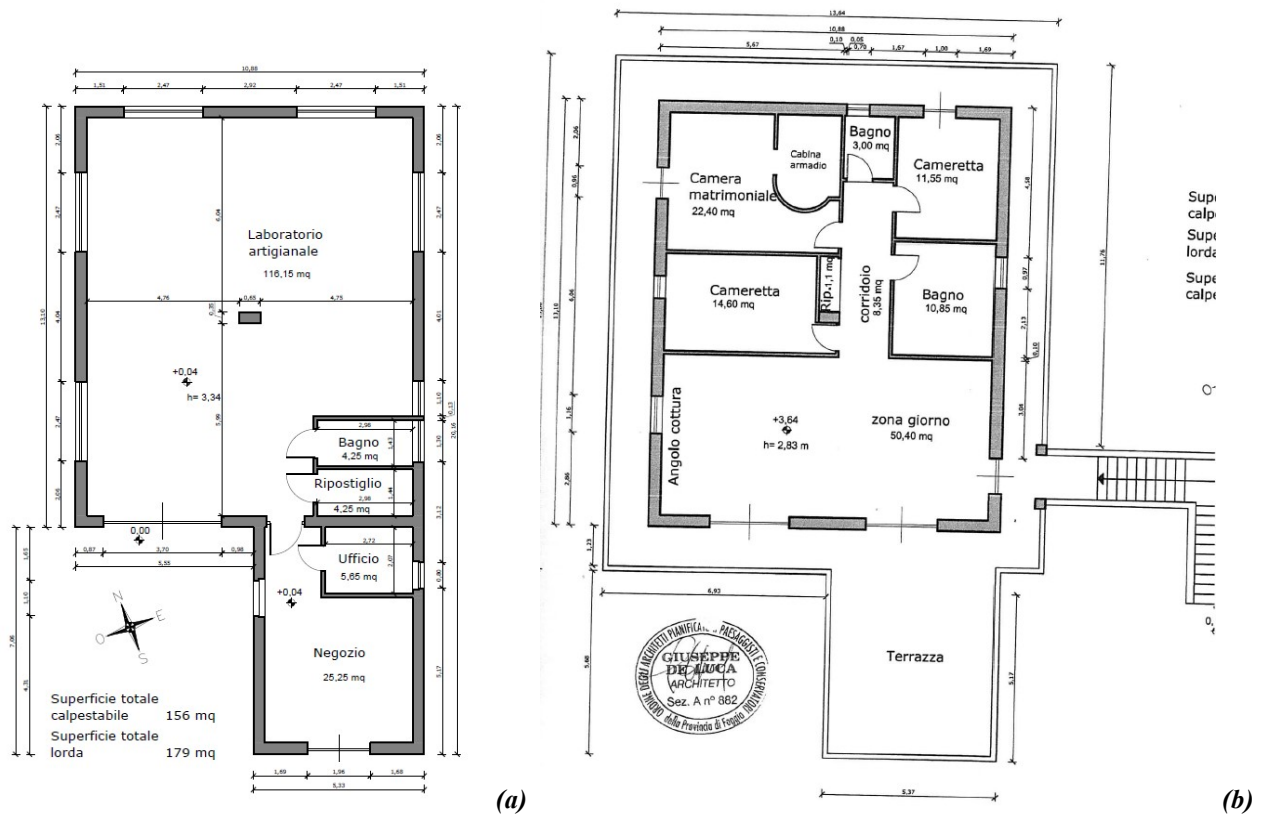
Planimetrie del fabbricato redatte dall'arch. De Luca: piano terra (a); piano primo (b).
